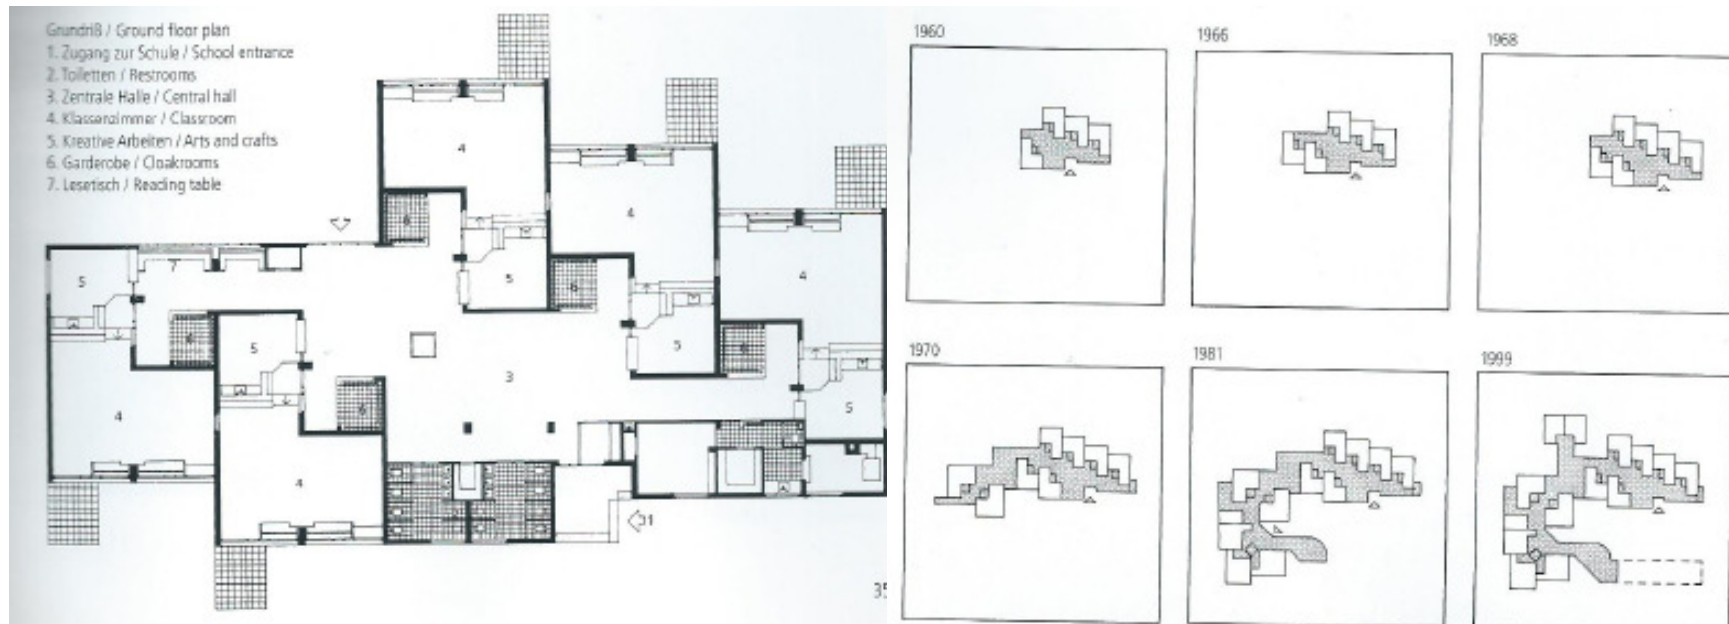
Grundriss mit mehrstufigen Erweiterungsplänen,
